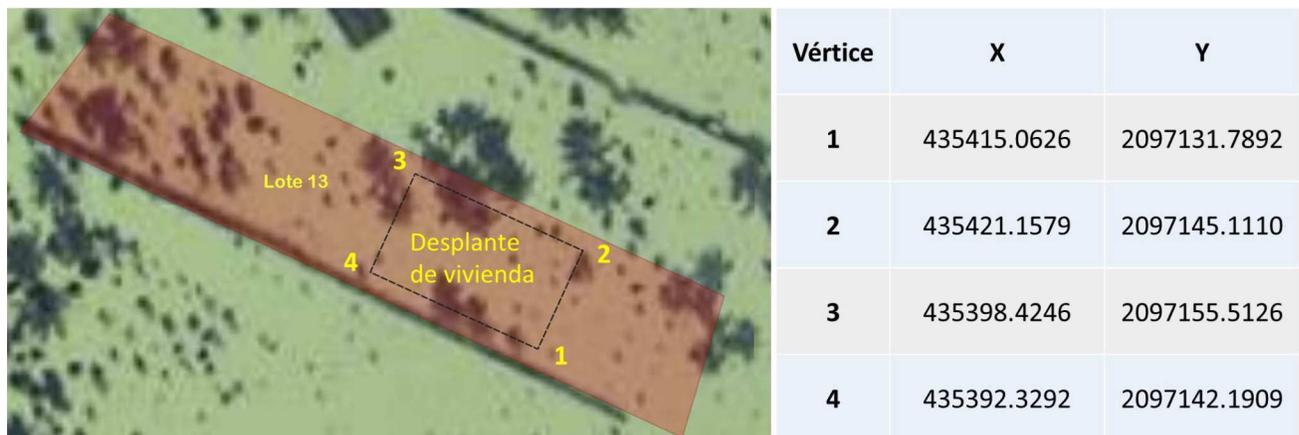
Ilustración del sitio preciso donde se pretende construir la vivienda Casa Paula.
